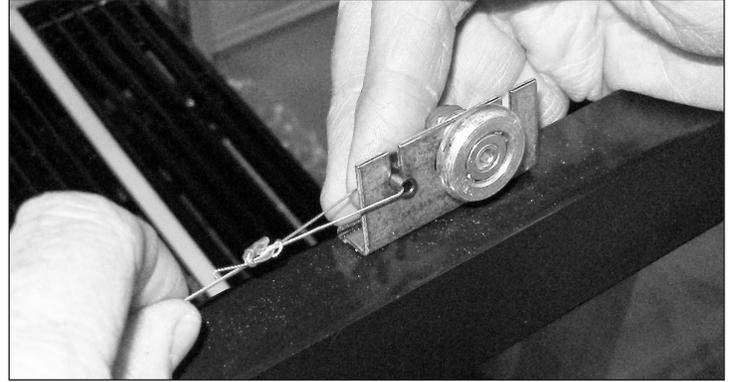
Retire el cable de la puerta del soporte de las ruedecillas.
